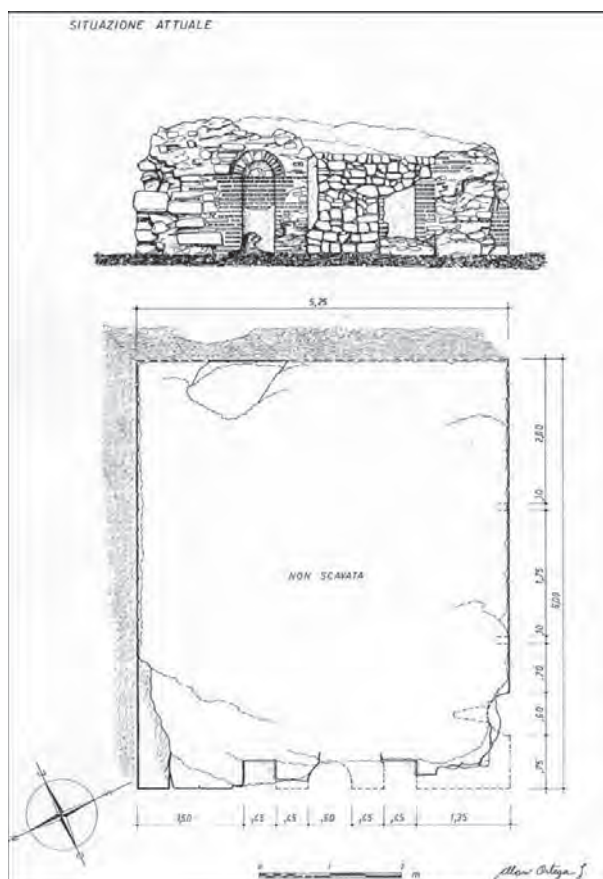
Planimetria e prospetto del lato occidentale della cisterna/fontana nr. 73 (A. Ortega 1989, Archivio SAIA).
